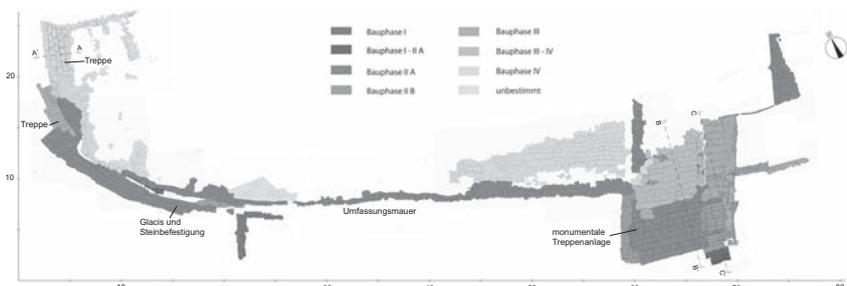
Tell Mozan. Grundriss der Tempel­terrasse mit Darstellung der Bauphasen. Abb. ohne Maßstab, im Original M 1:50, 2009.
